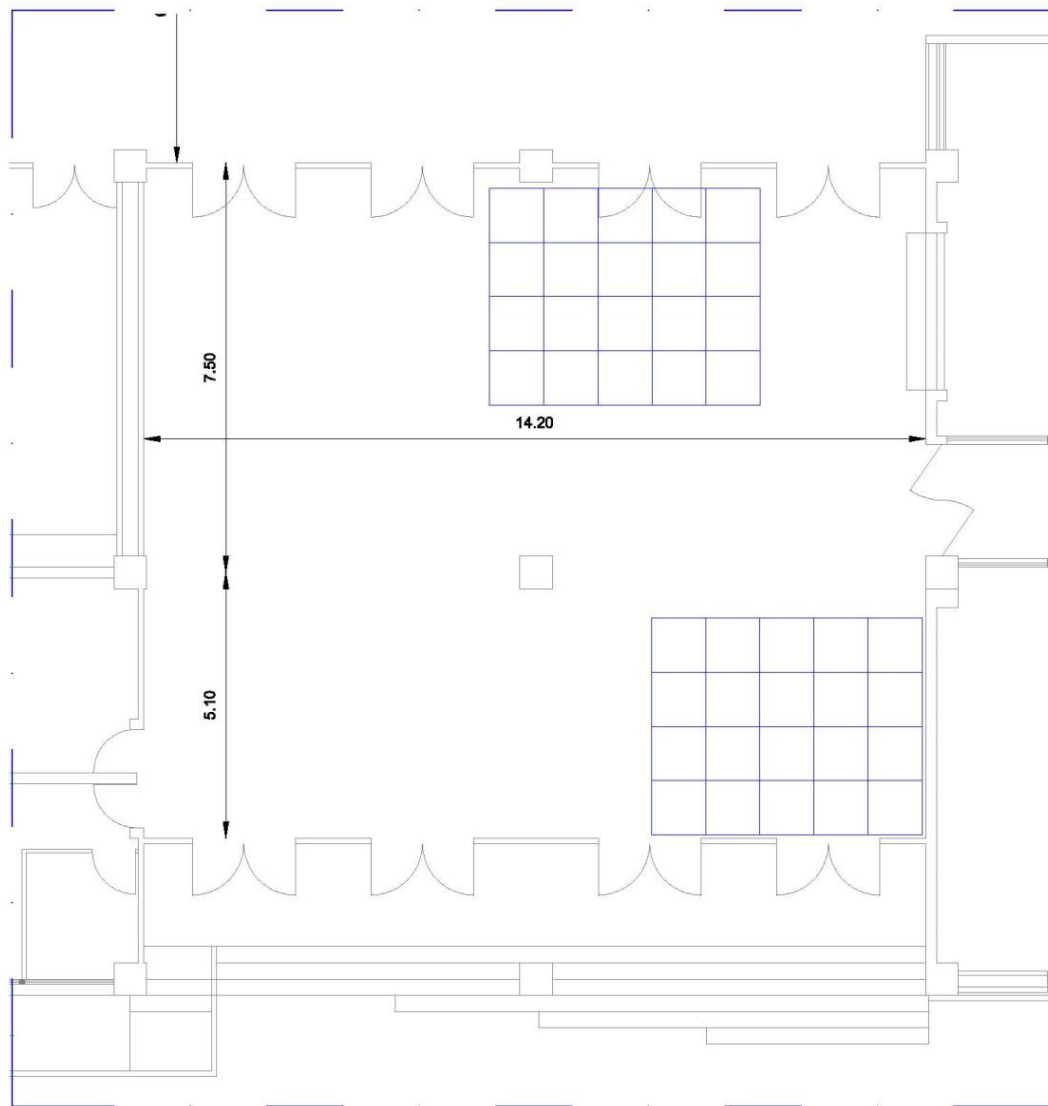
Pavilhão de Civil, Átrio Exterior, 2 slots de 20 m²
